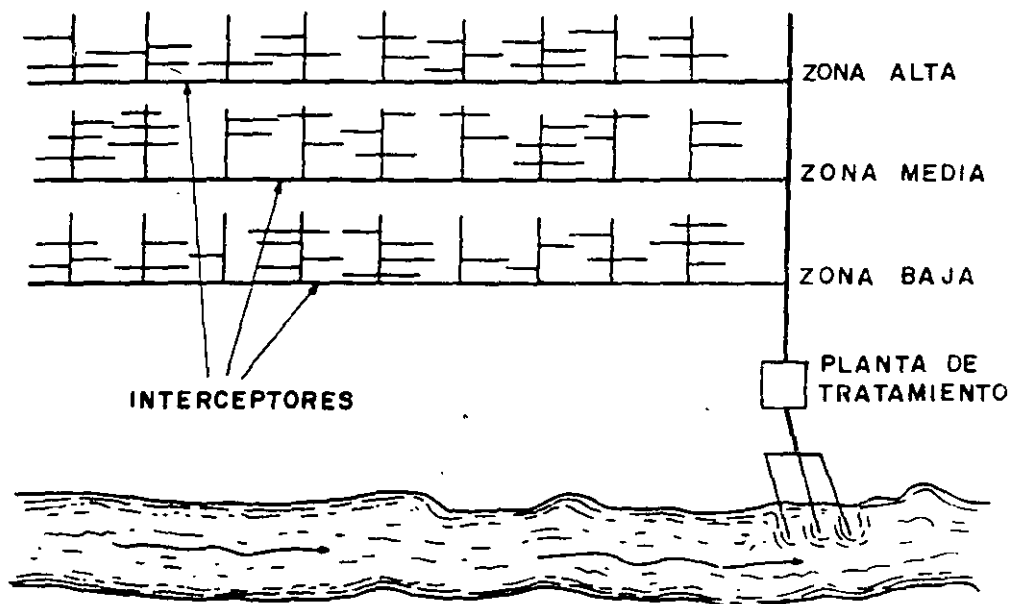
Conductos interceptores en un sistema de alcantarillado
